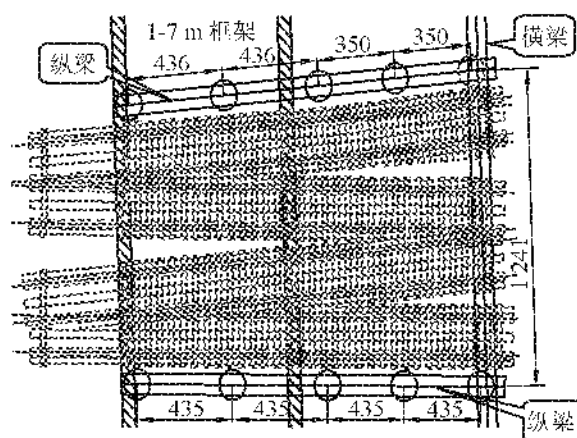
线路加固部分平面图(横梁仅示一组)(单位:cm)
